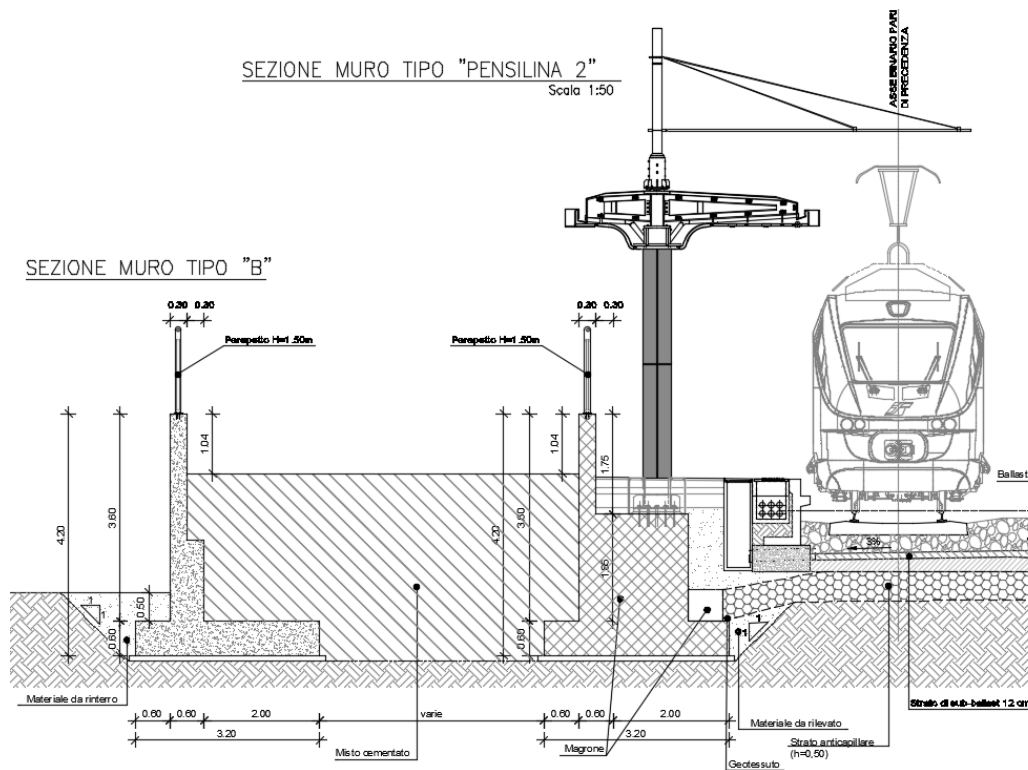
Sezione trasversale pensilina su "pensilina tipo 2 - FV01"
